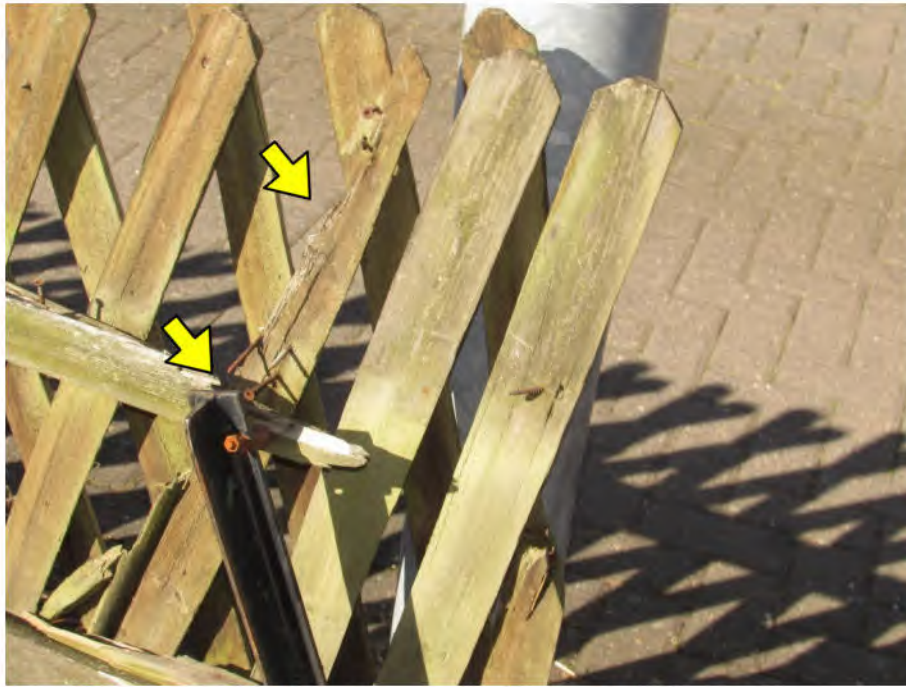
bauliche Außenanlagen: schadhafter Holzjägerzaun
